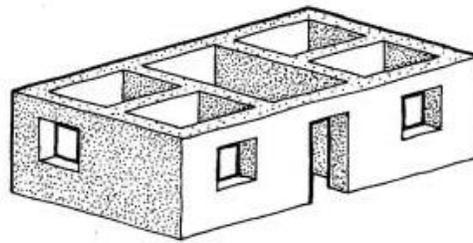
, Tipología de vivienda segura de adobe sin refuerzo interior. Imagen recuperada de Blondet et al. (2003).
